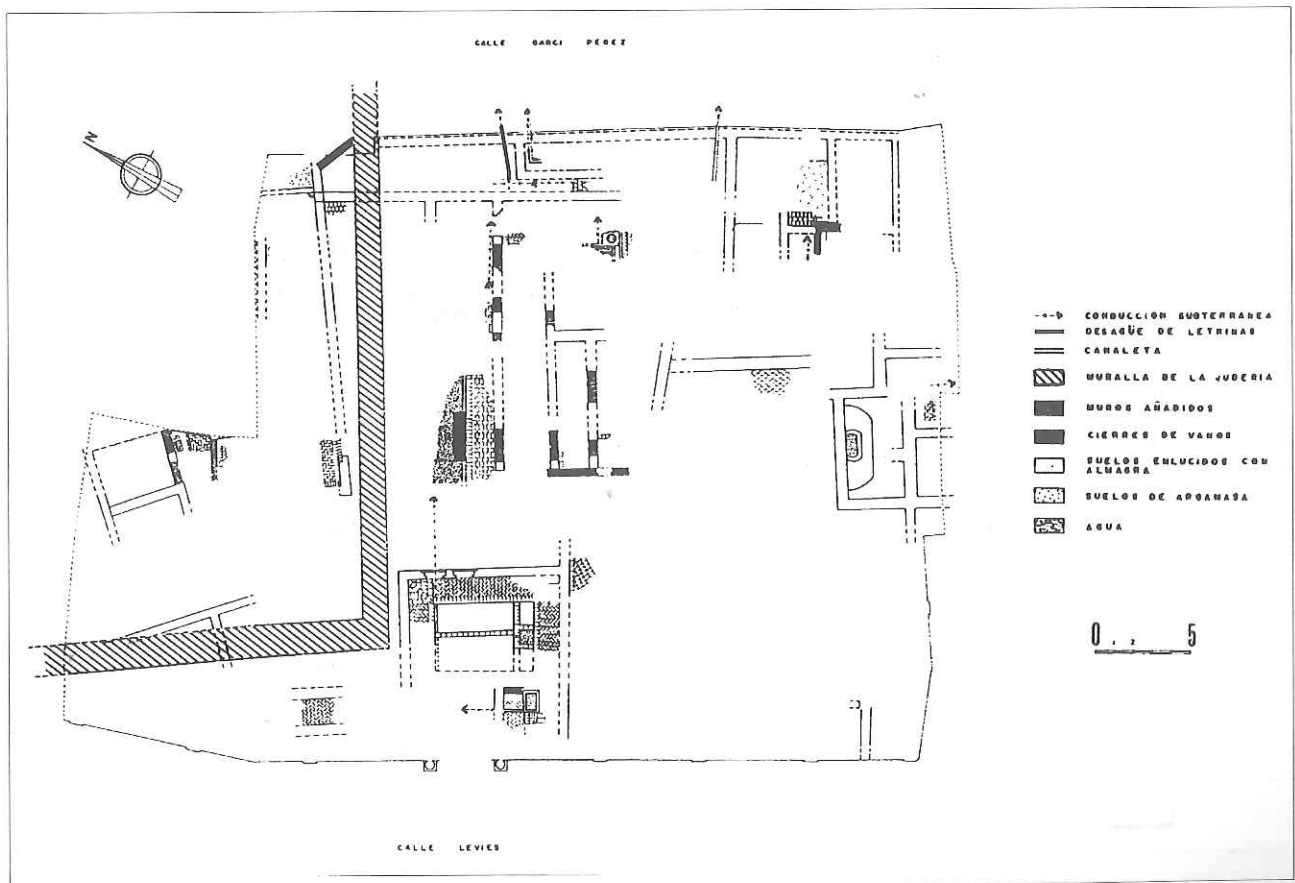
Planta del edificio con las reformas bajomedievales, incluido el tramo de muralla que atraviesa el edificio
